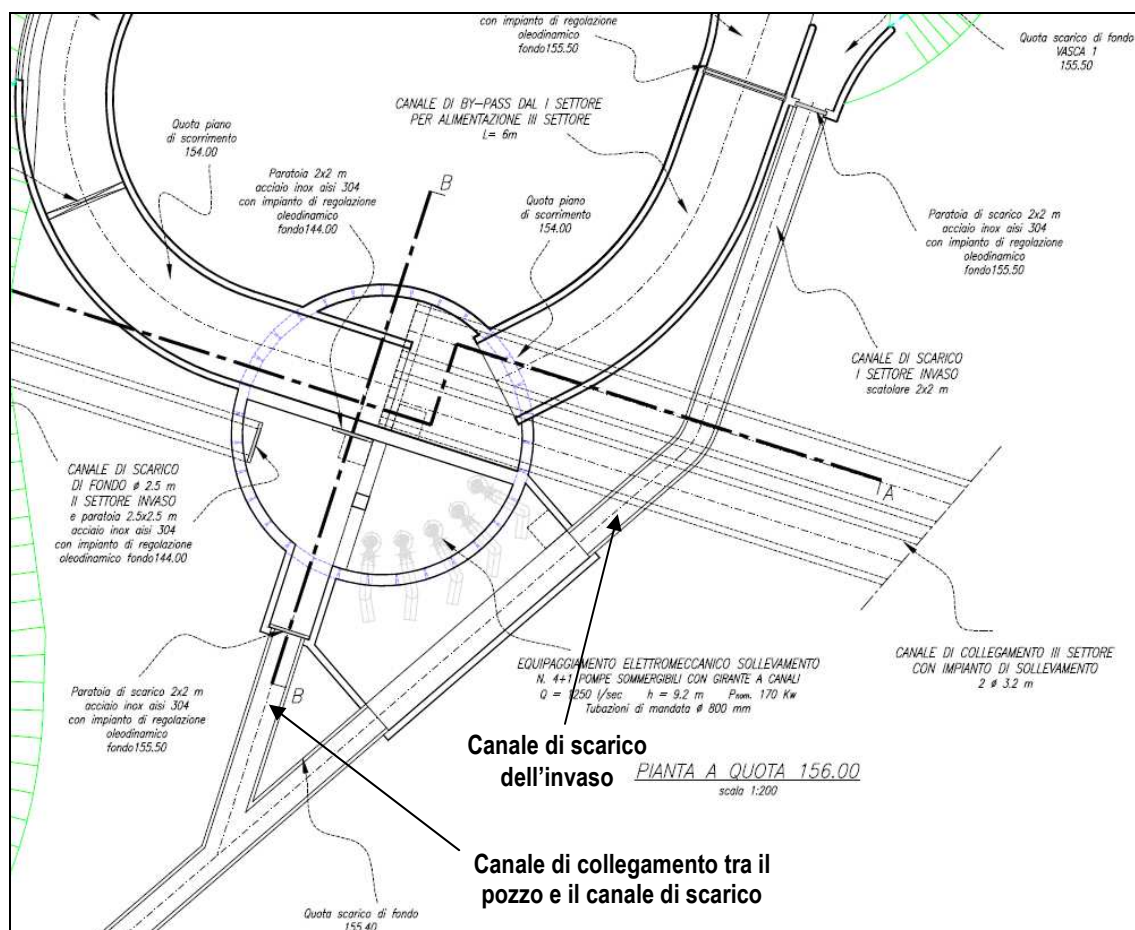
Planimetria con indicazione delle opere di scarico dell'invaso
